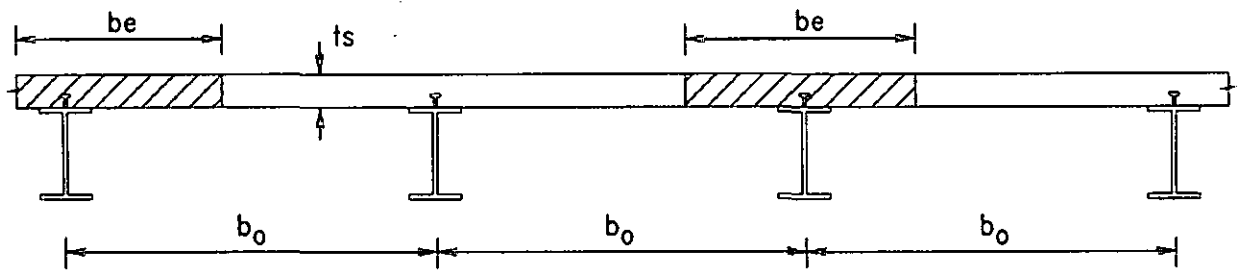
Ancho Efectivo del Patín de la Sección Compuesta
